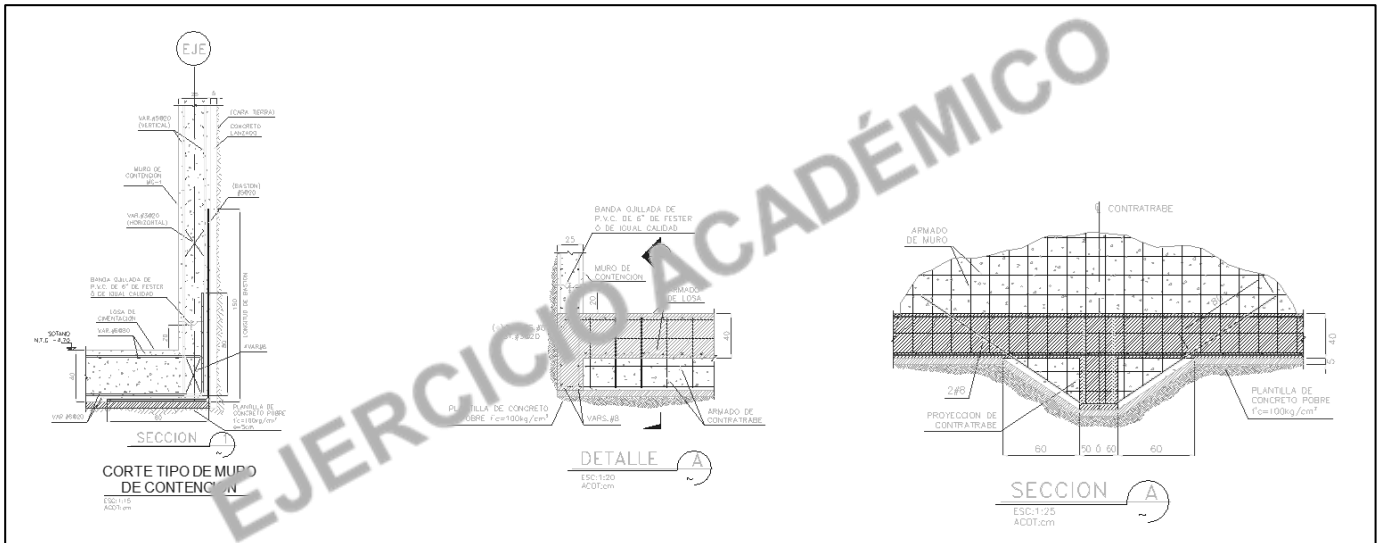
Plano CIM-01 Detalles de unión de muro de contención a losa y armado de contratabes principales en unión con el muro. Fuente: archivo de obra.
